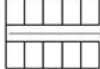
Plan Tipi 3 (Sosyalleşme Cepleri Oluşamamaktadır)
